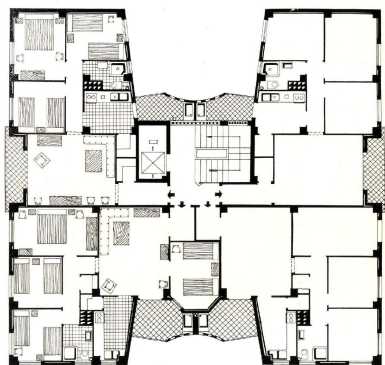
Planta tipo de una de las torres del Grupo 14 de junio.
